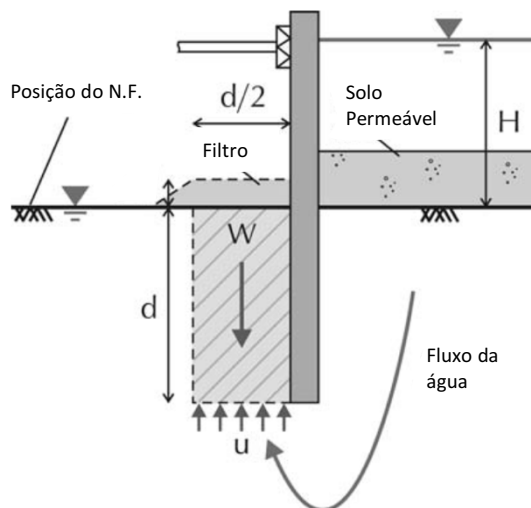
Ações aplicadas numa cortina sujeita a levantamento hidráulico (adaptado^[7], 2008)
